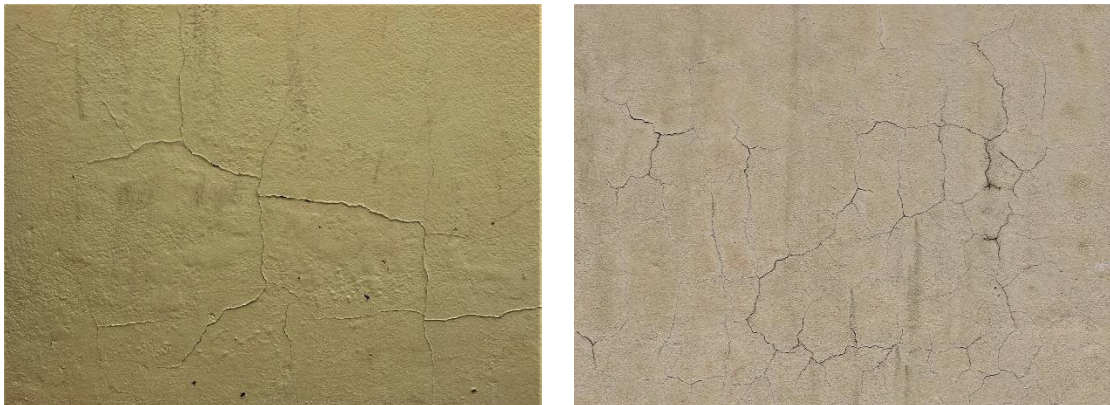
Fissuração e degradação do revestimento por pintura das paredes exteriores
